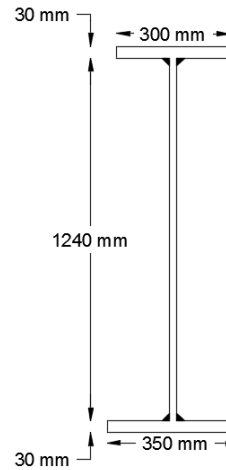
Cordón de soldadura en el patín inferior y superior con el alma de la viga (Sección transversal).
